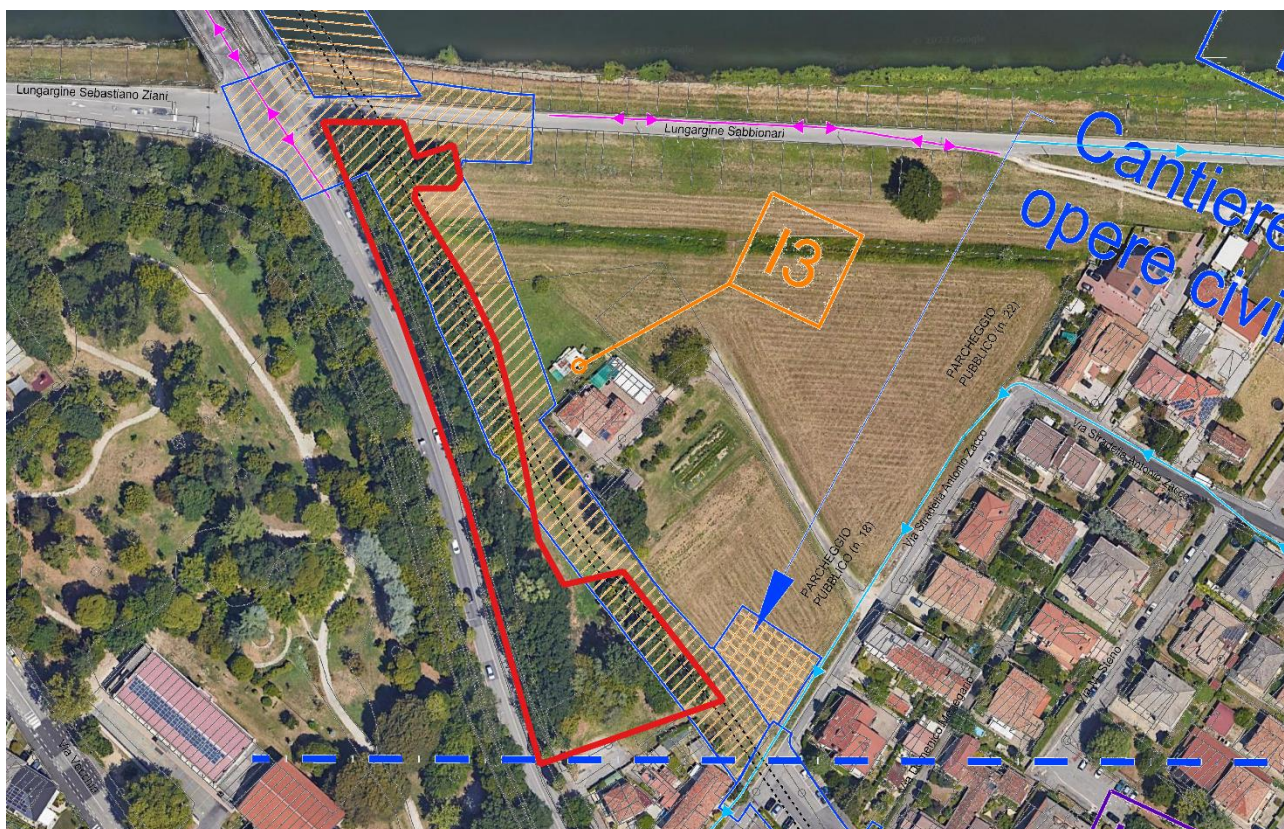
sovrapposizione dell'area di progetto e area a verde interessata dall'esecuzione della linea tramviaria
